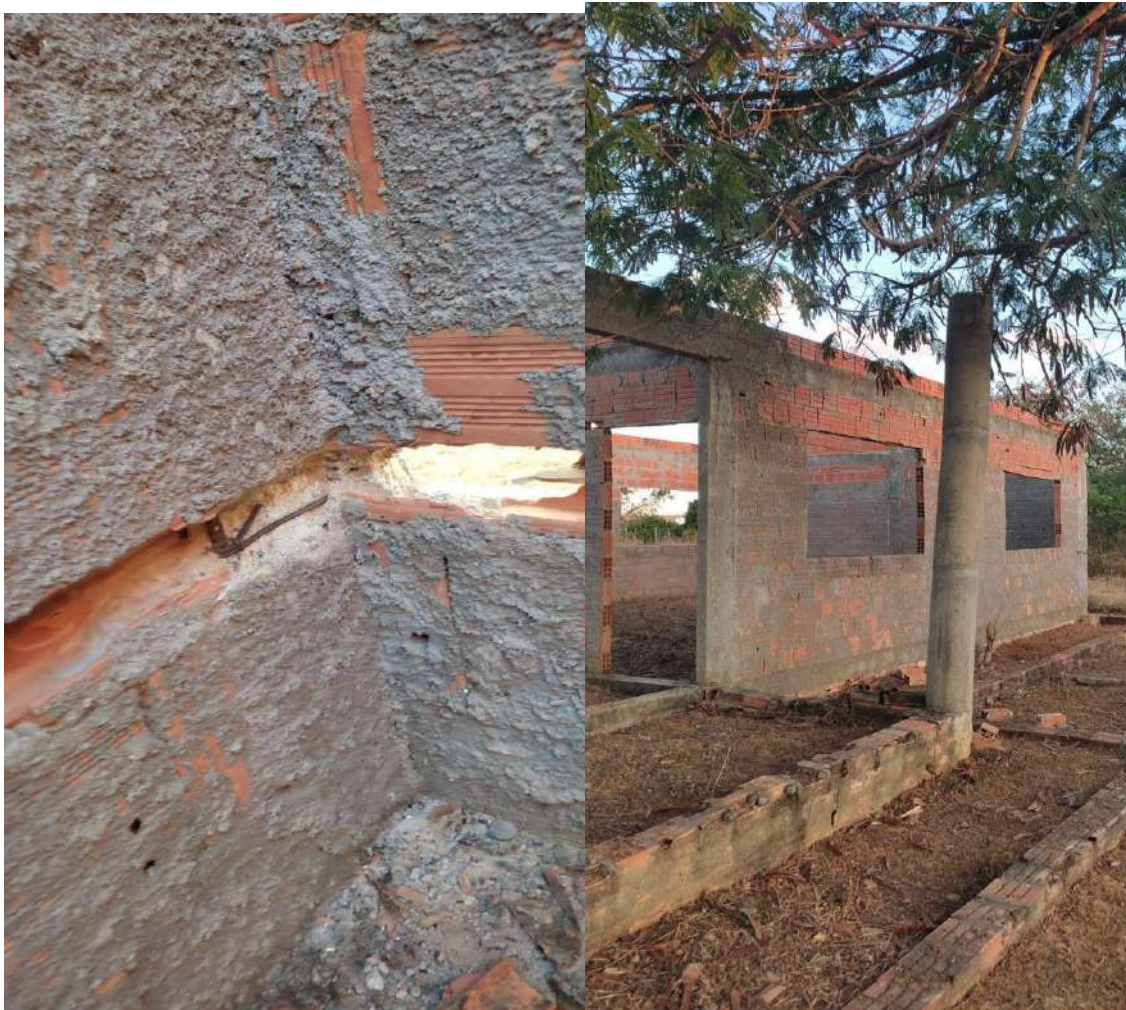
1- Armação de pilar exposta. 2- Alvenaria quebrada. Fonte: elaboração própria
